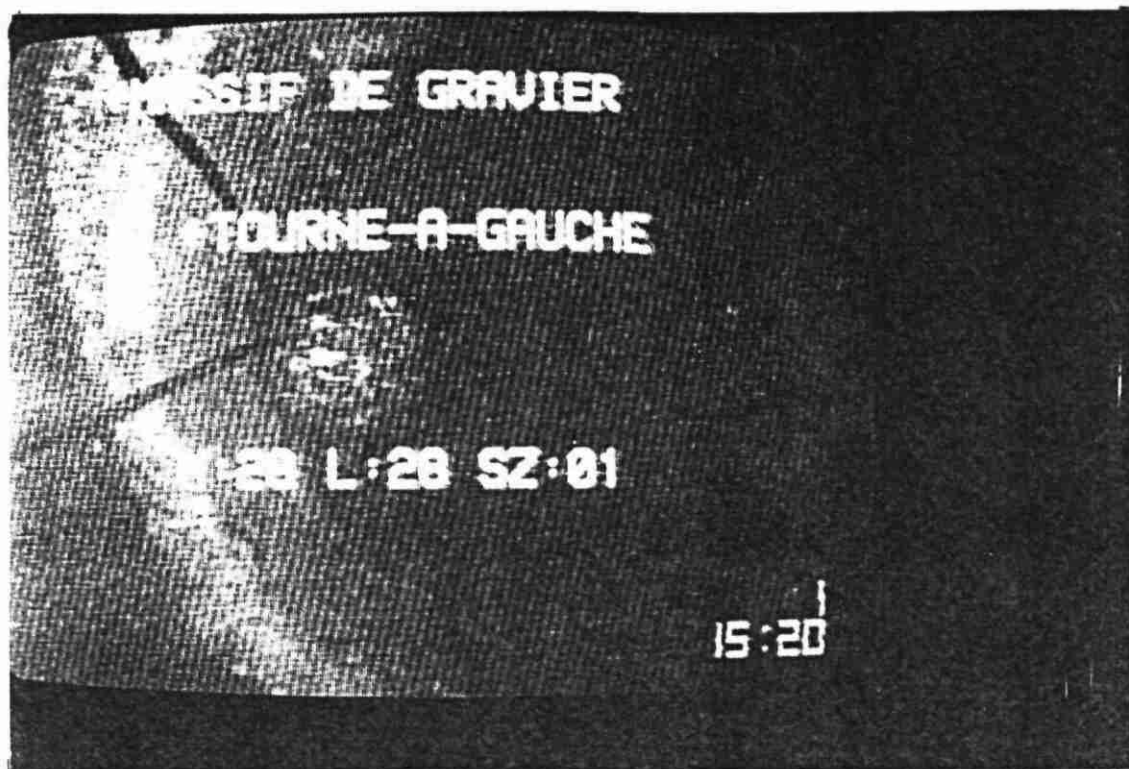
Prof. 118,3 m : Tube d'extension inox $\varnothing$ 8" 5/8 (219 mm)
